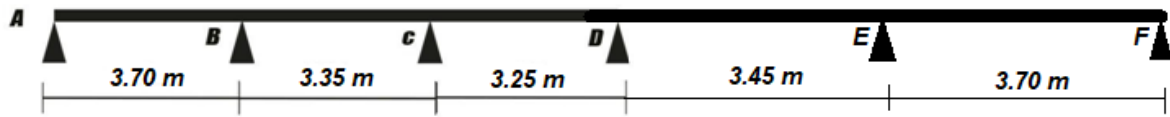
Schéma du 1^{eme} type de poutrelle.
